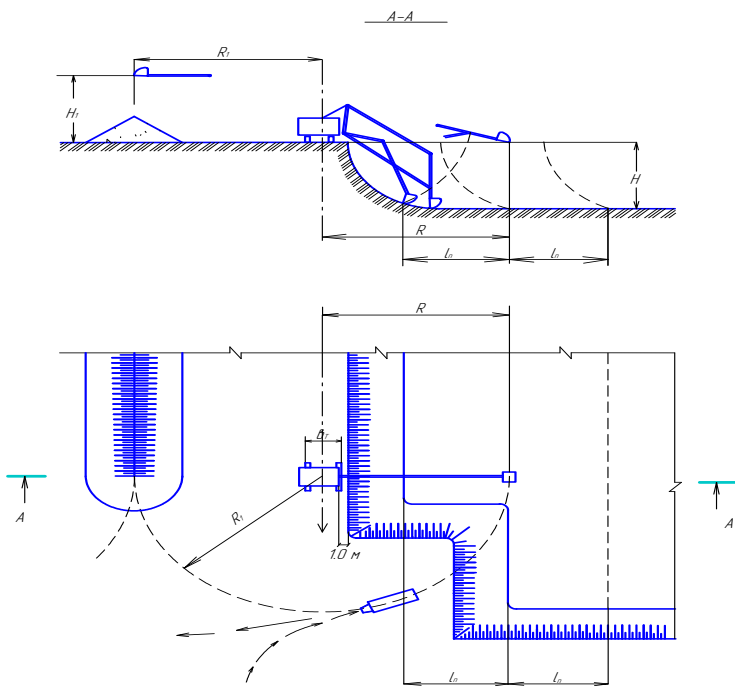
Примерная технологическая схема разработки котлована боковой продольной проходкой экскаватором, оборудованным обратной лопатой:
